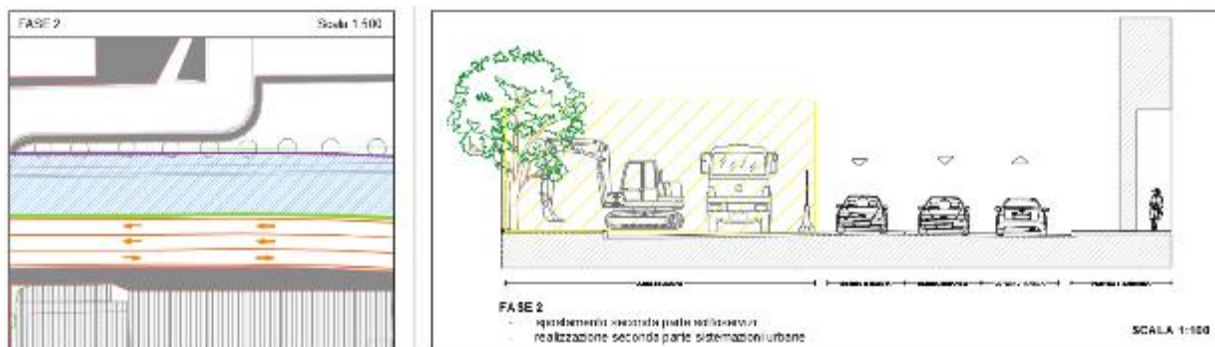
Tipologico cantiere con sede centrale Fase 2
